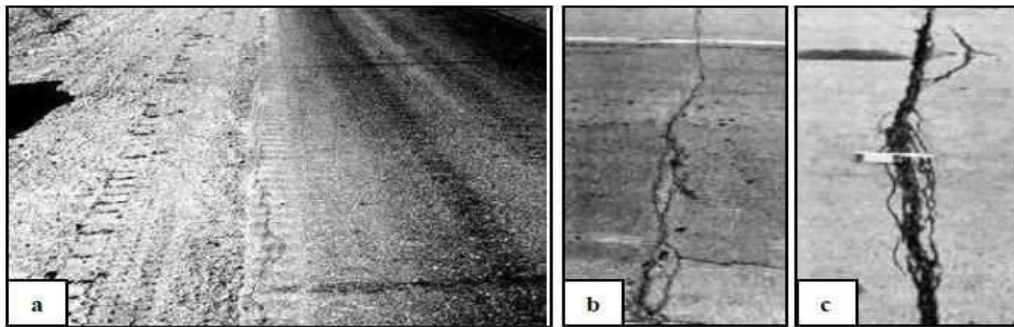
Fisura de reflexión, severidad bajo (a), medio (b) y alto (c).
